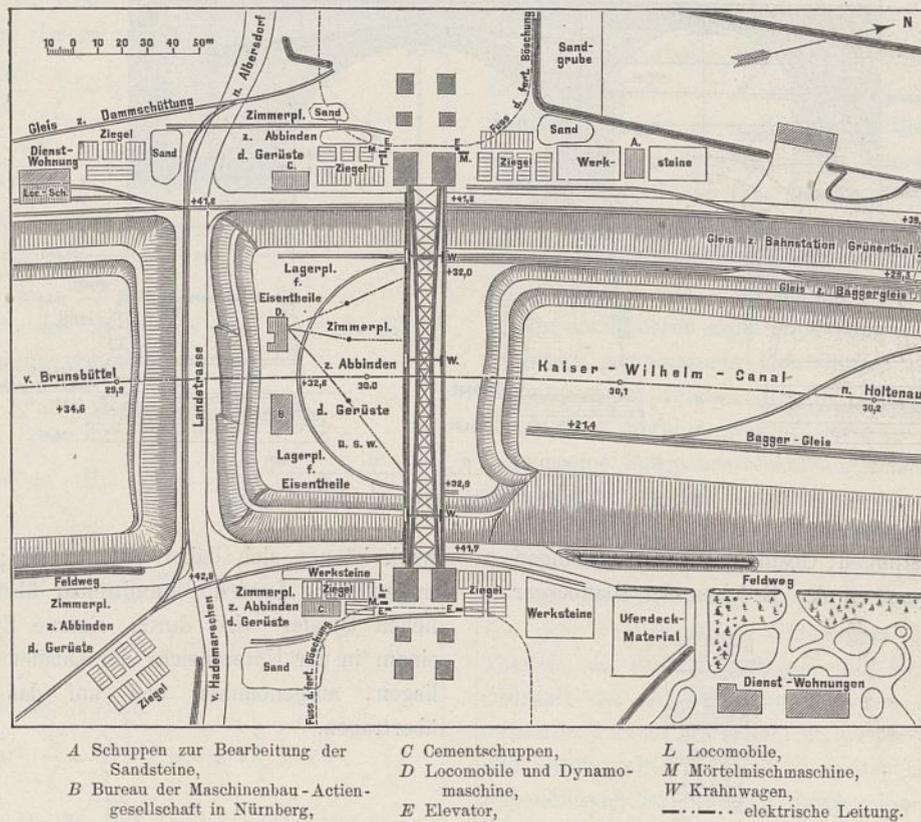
Lageplan der Brückenbaustelle bei Grünenthal.
